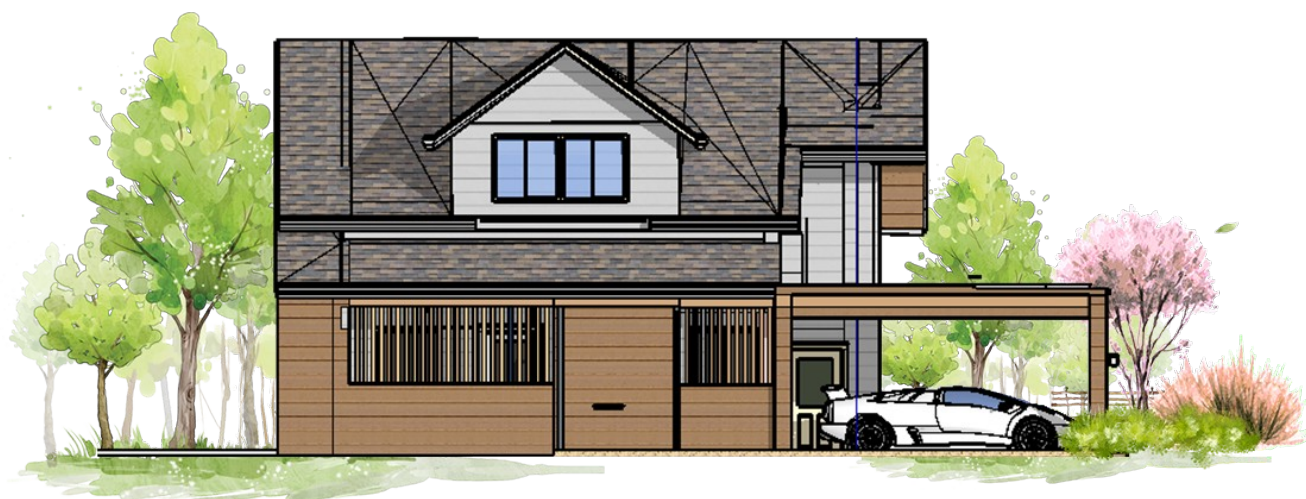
Решение фасадов жилого дома (западный фасад)
